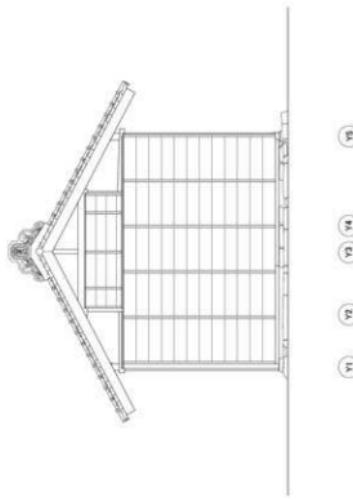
長屋門 竣工 東立面図 S=1/100
